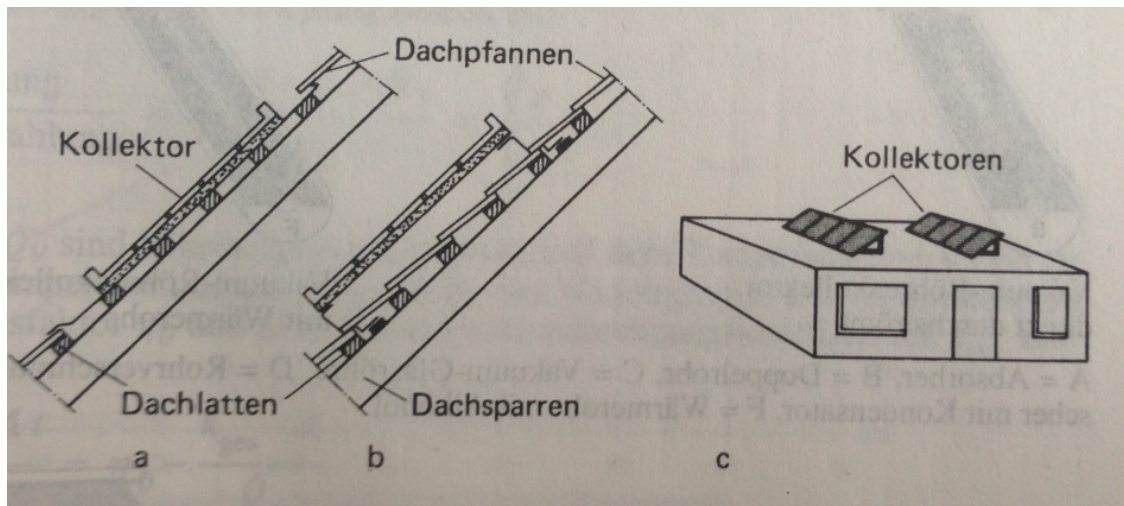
Kollektoreinbau, a) Dachintegration, b) Aufdachmontage, c) Flachdachmontage (RSS, S613)
